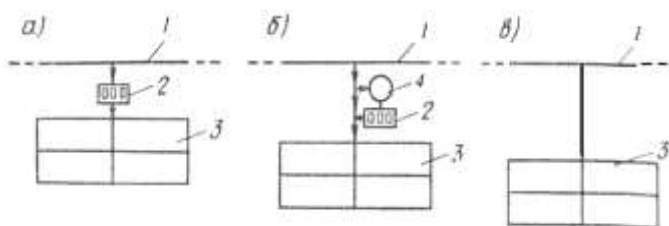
Схемы подключения внутриплощадочной водопроводной сети к городскому водопроводу:
